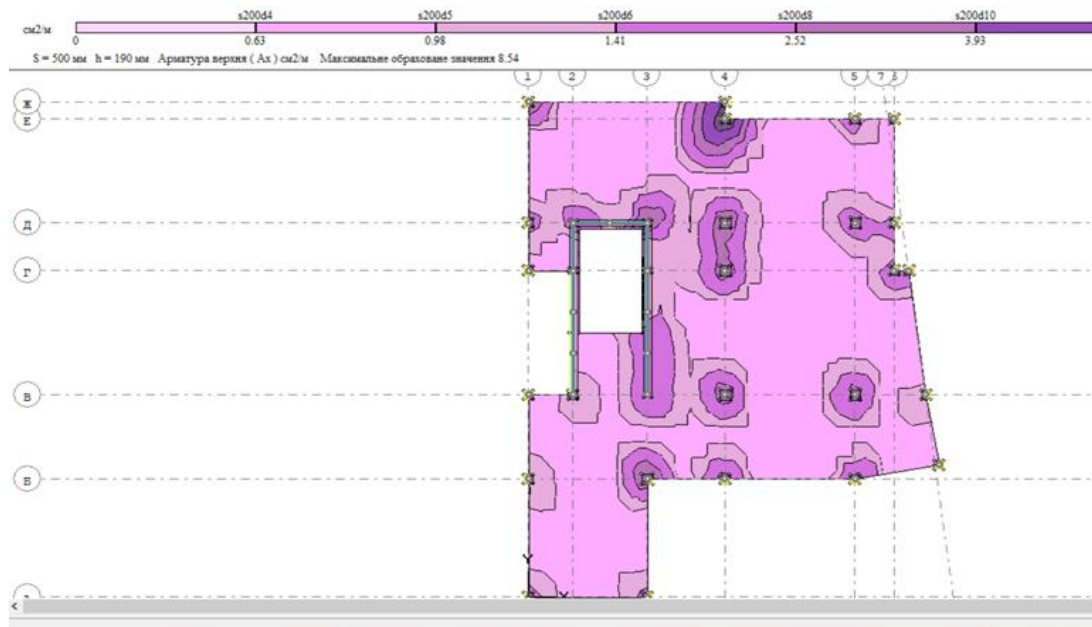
Арамування плити перекриття верхнє по осі Х
